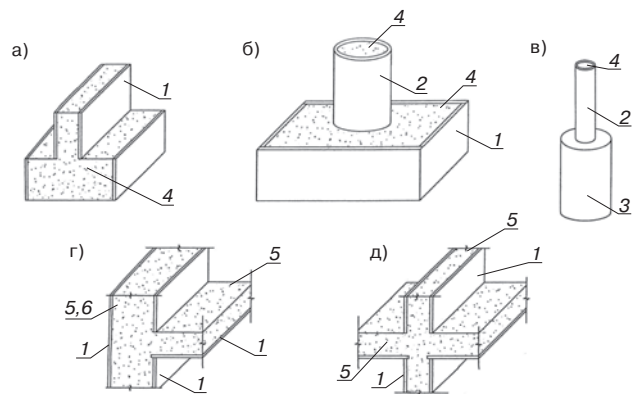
Использование асбестоцемента в качестве несъемной опалубки: а – ленточные фундаменты, б, в – столбчатые фундаменты; г – сопряжение перекрытий с наружной стеной; д – с внутренней; 1 – АЦ лист; 2 – АЦ труба; 3 – буронабивная свая; 4 – «К»; 5 – «КТ»; 6 – «Т» бетоны
